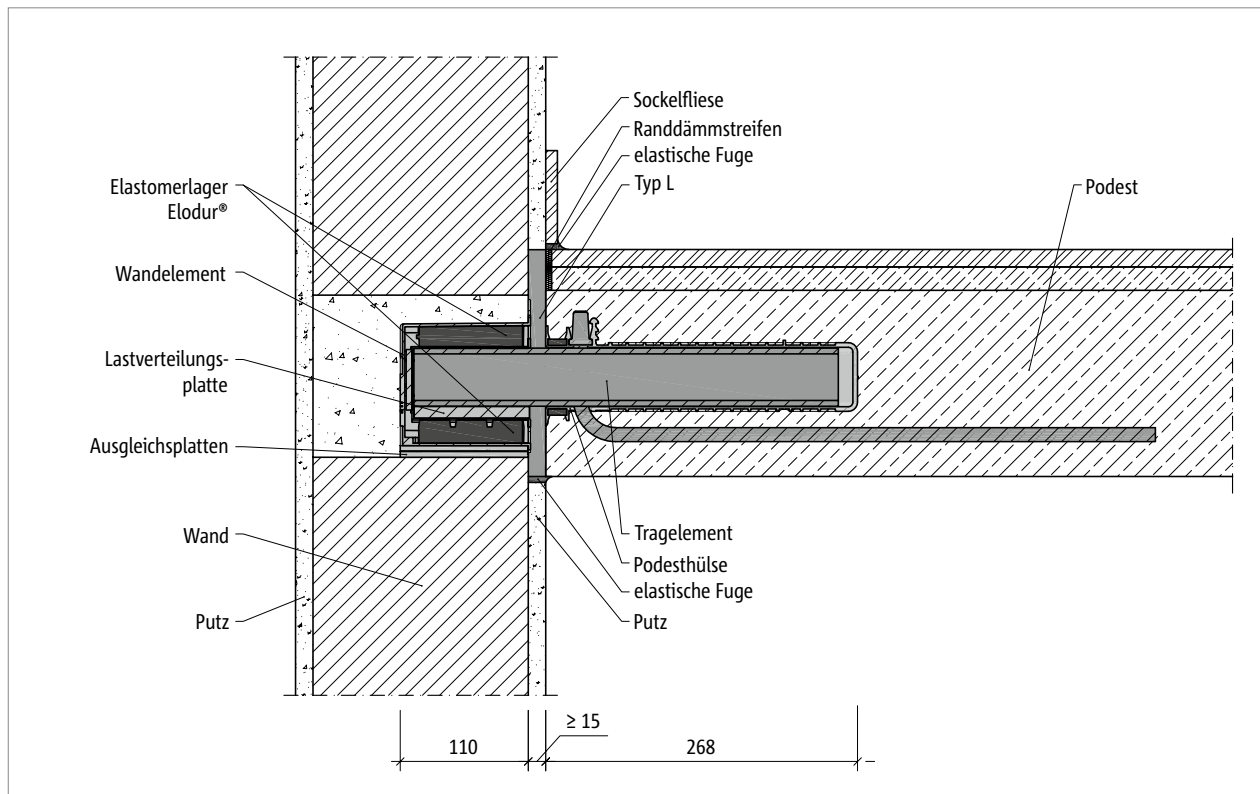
Schöck Tronsole® Typ P: mit Ortbetonpodest und Tronsole® Typ L
